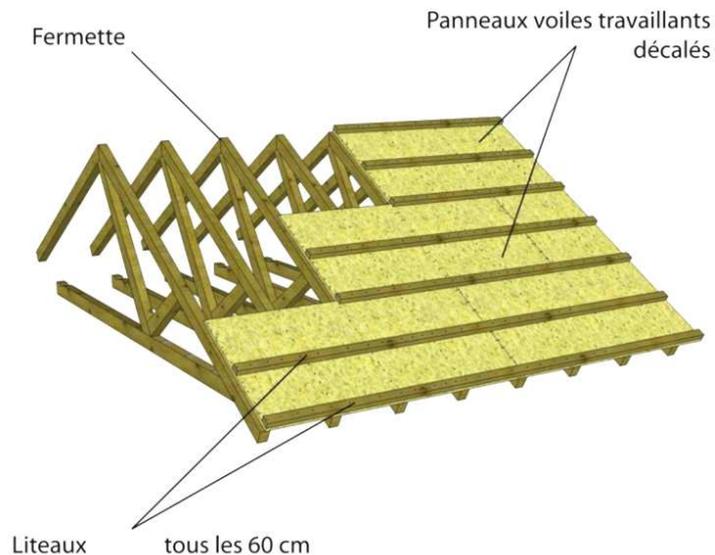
Contreventement d'une toiture à fermettes par voiles travaillant.
